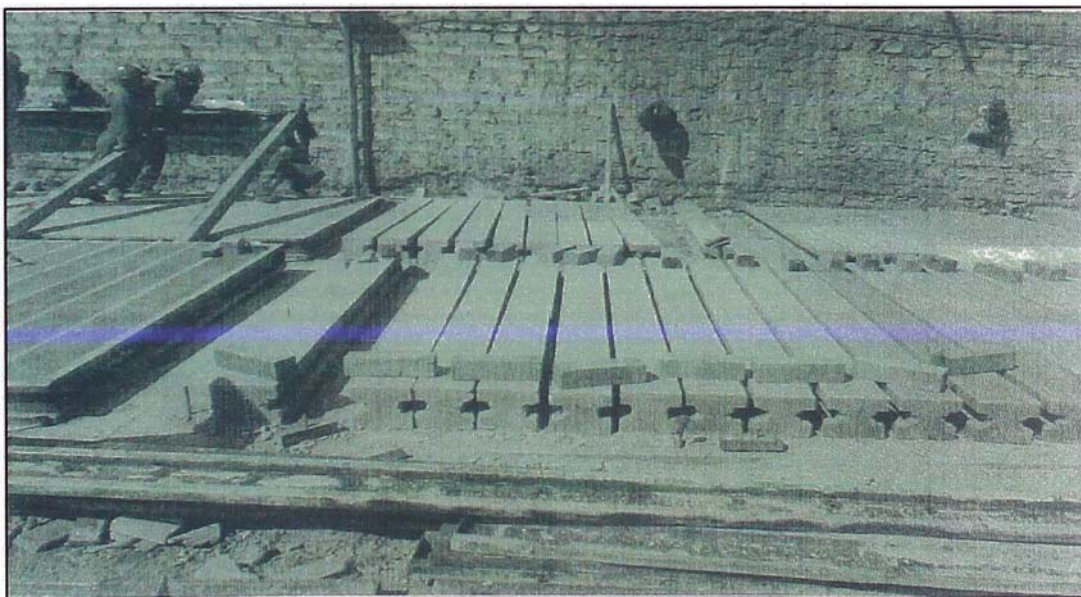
Fabricación de Columnas – Desencofrado de columnas
